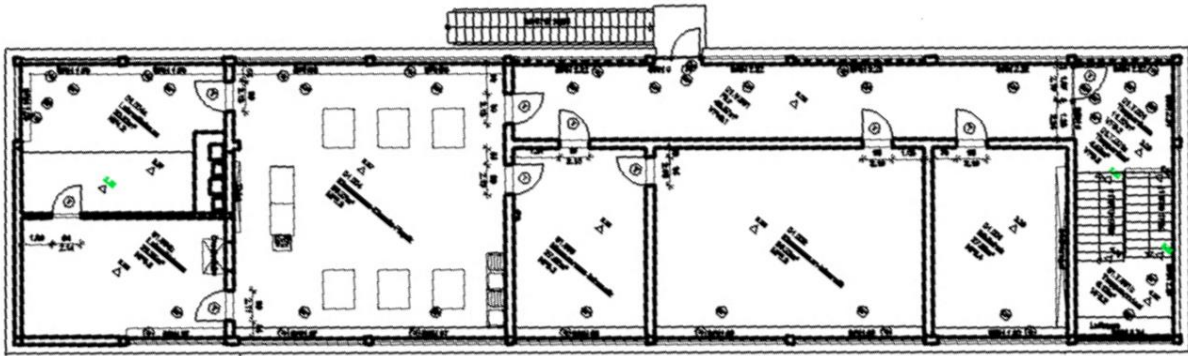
Ausschnitt 1. OG Grundriss Schulgebäude Trakt A
